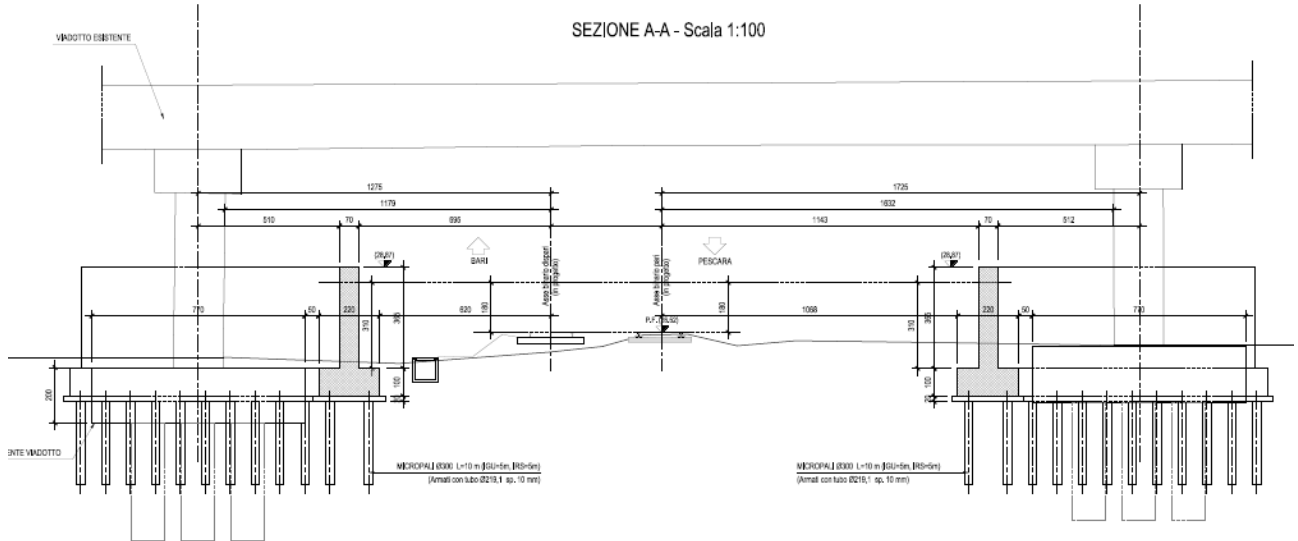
Opere di protezione pile SS16-SP31 – Sezione trasversale
